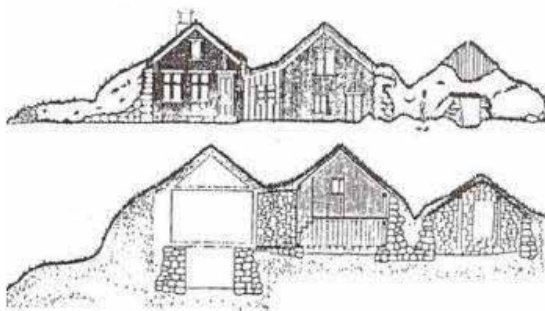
| Fachada Sul e Corte - Habitações na Islândia
